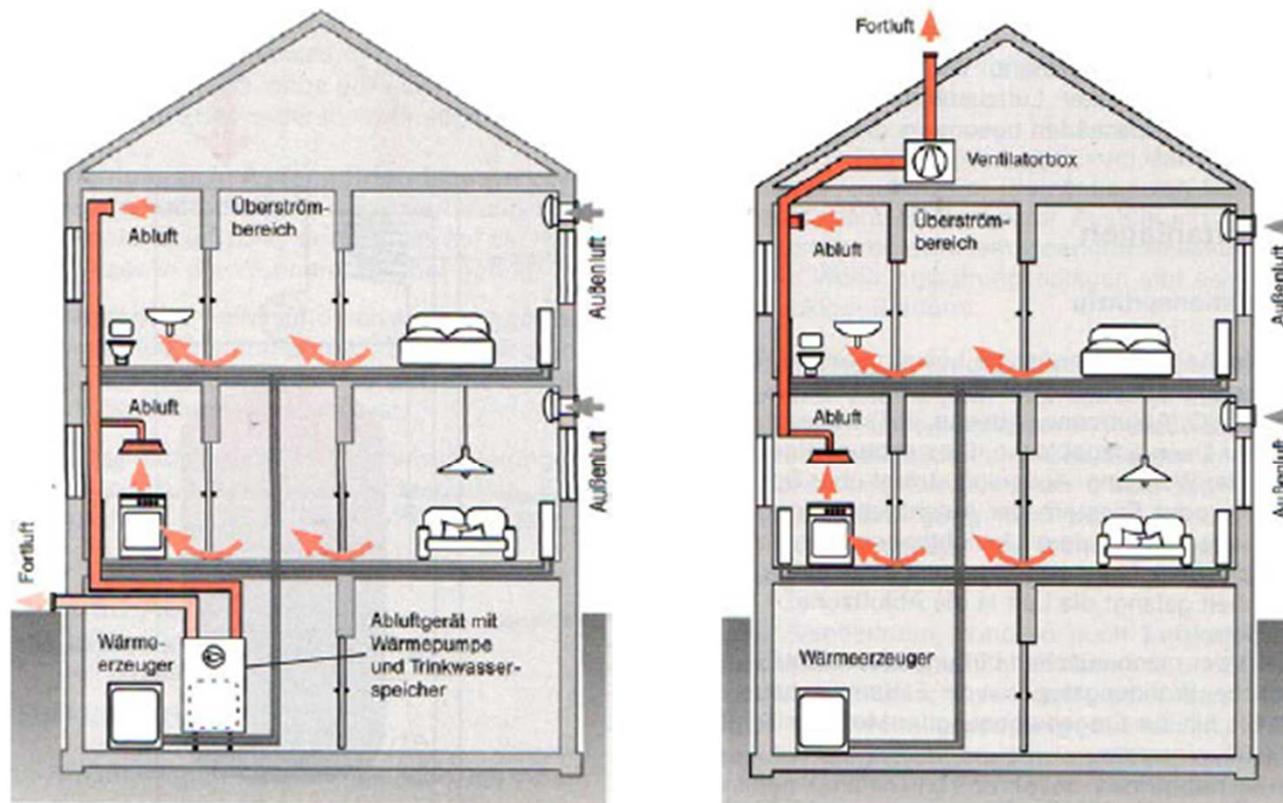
Schema einer Abluftanlage mit und ohne Abwärmenutzung per Wärmepumpe zur Trinkwarmwassererwärmung und passiven Außenluftdurchlässen, Quelle: RWE Bau-Handbuch, Seite 14/36 und 14/45
